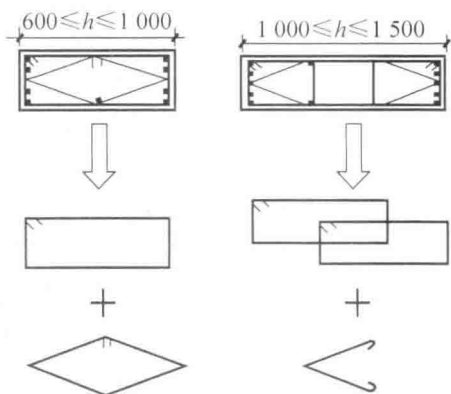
钢筋混凝土柱中的复合箍筋(单位:mm)
